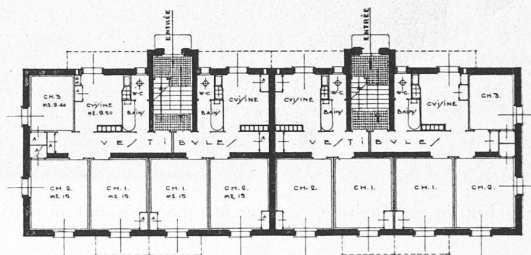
Plan du rez-de-chaussée et des étages. — 1 : 400.
